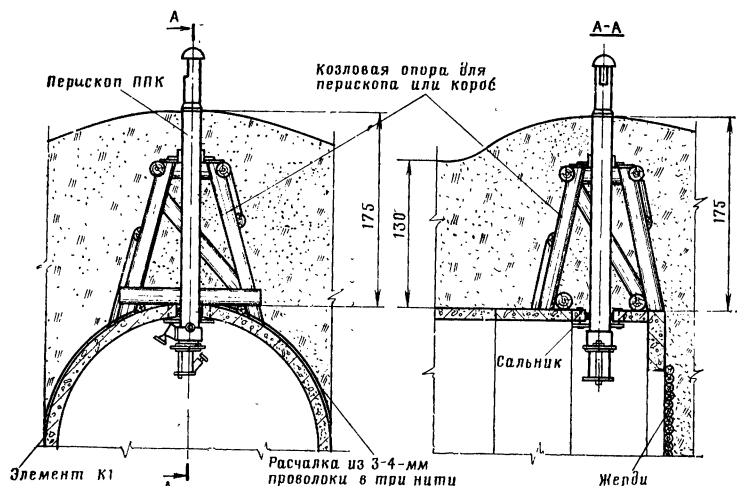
Крепление перископа в сооружении из железобетонных элементов
